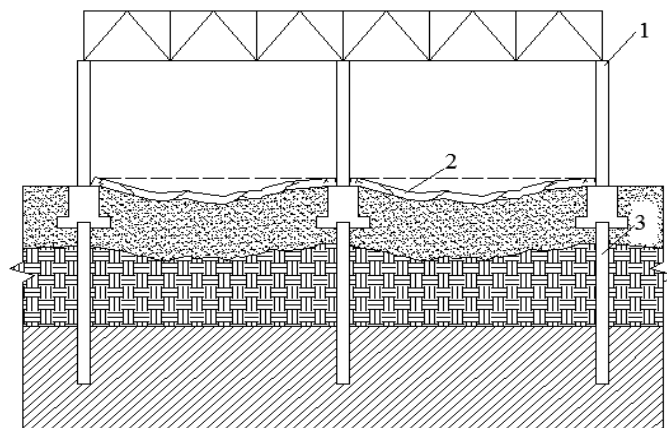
Типичная схема деформации полов по грунту при наличии торфа в основании: 1 – промышленное здание; 2 – монолитный бетонный пол; 3 – свайный фундамент под колонны каркаса
